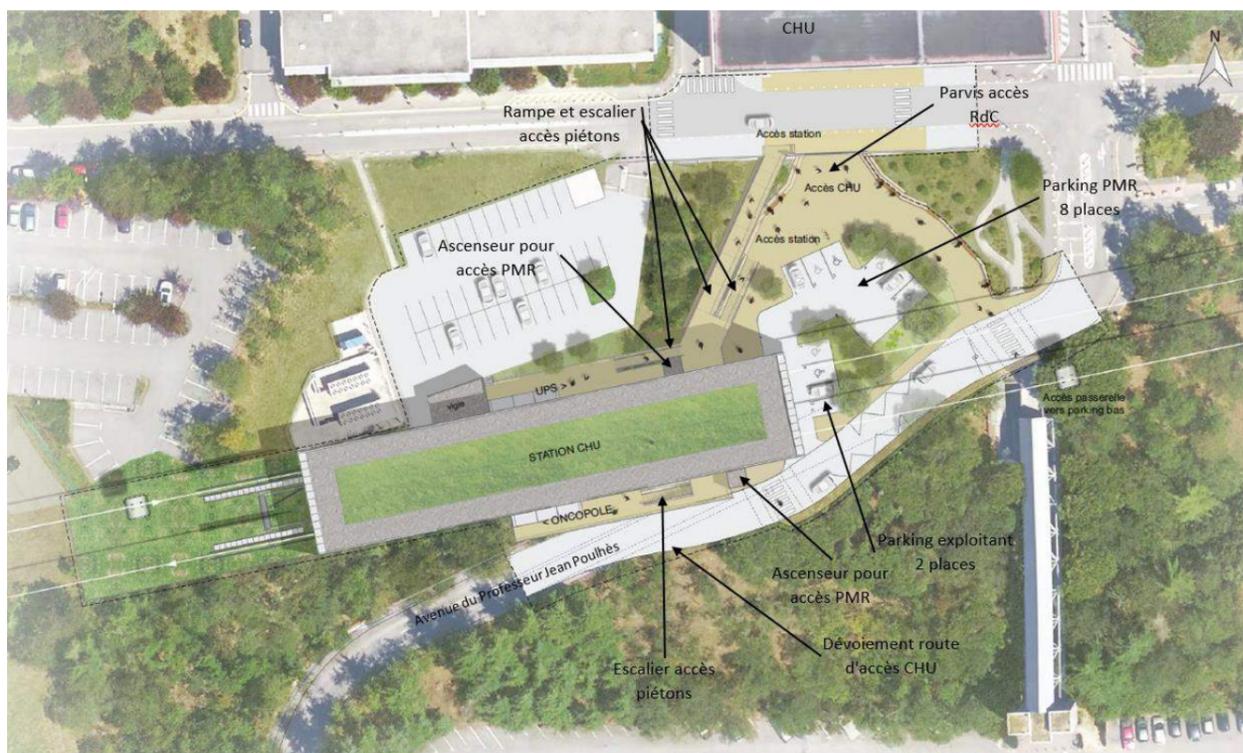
Plan de masse de la station CHU (source : Groupement POMA, 2018)
